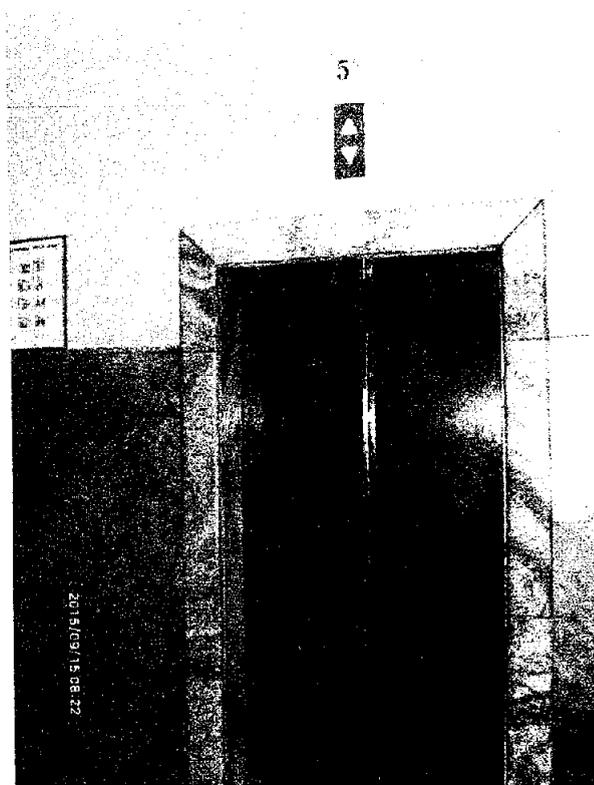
Foto do Hall do Elevador no 5º Pavimento
